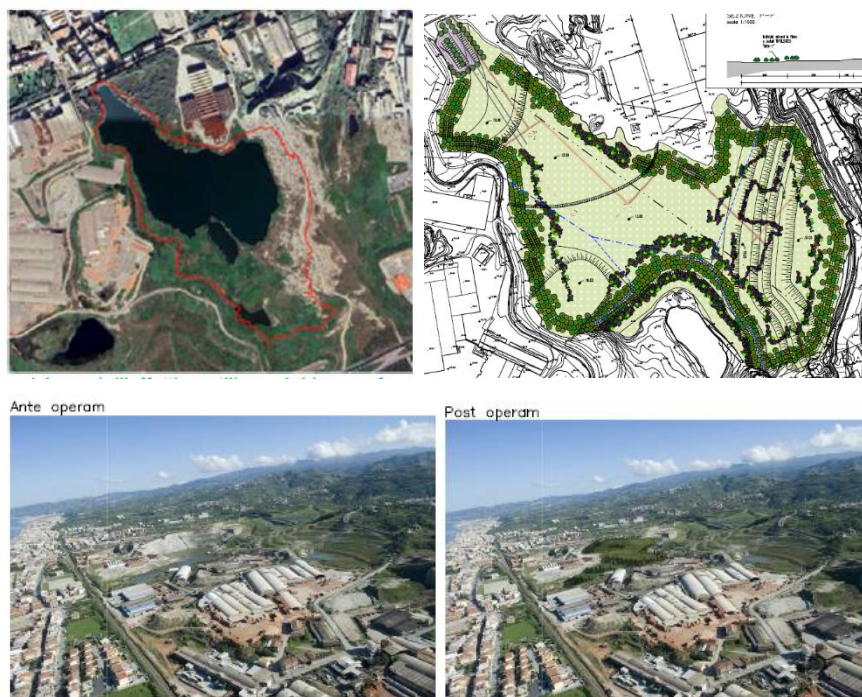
SRA4 (SR06) Sito di recupero ambientale a Venetico – Planimetria della sistemazione a verde finale e fotoinserimenti (cfr. AM0147_F0)
